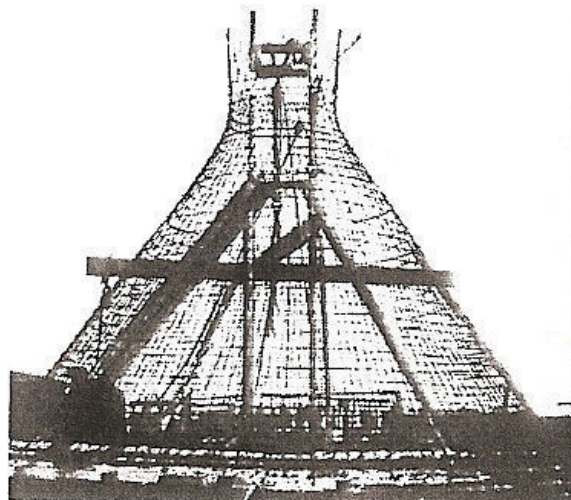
Armado de los cajones de cimentación de Sancti Petri. (6)
